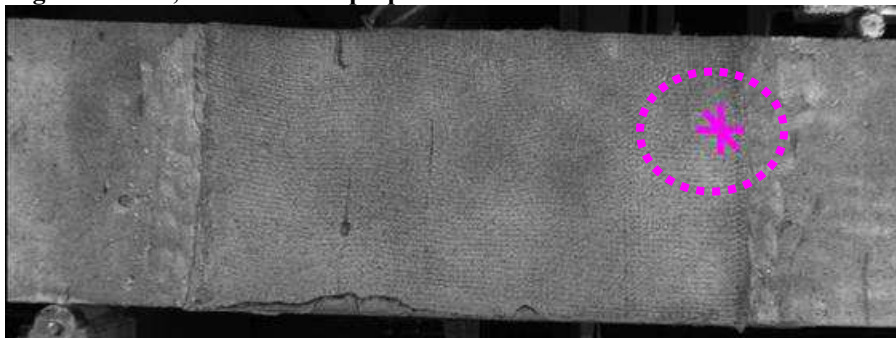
Position de l'extensomètre par corrélation d'images verticale, horizontale et perpendiculaire à la fissure, sur la poutre « R40-B-U-Is-TRC(5) »
